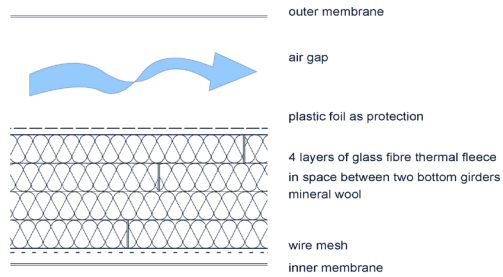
Sporthalle Fürth, detaillierter Dachaufbau
